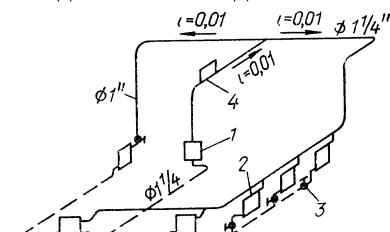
Схема двухтрубной системы отопления с подоконной разводкой подающими трубопроводами.
